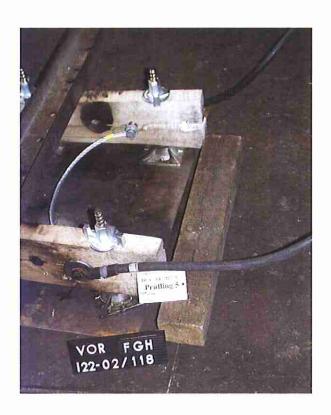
Prüfaufbau mit Prüfling 6 vor Versuch 122-02/118
